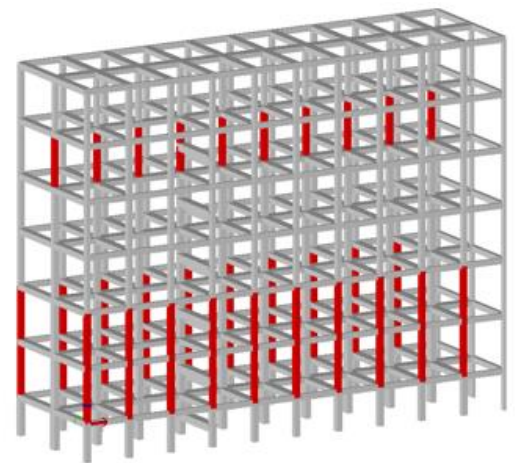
Modello US B1 - PROSAP, Archivio Sezioni, Proprietà n° 5: Pilastro 45 x 50, con inquadramento.
